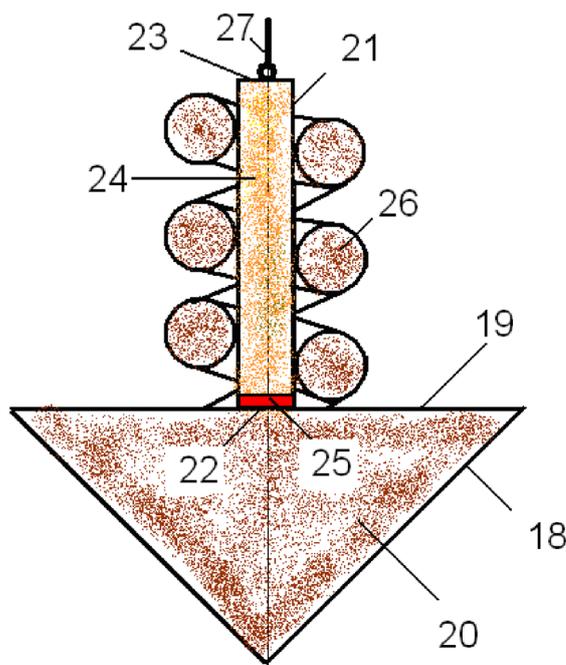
Общий вид штучного звукопоглотителя акустической конструкция цеха
